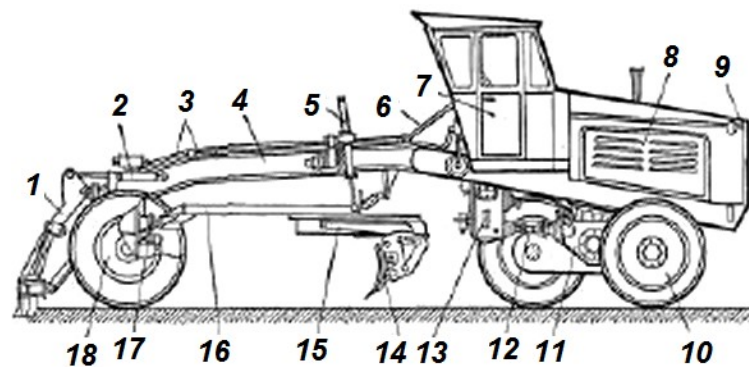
Конструктивна схема автогрейдера: 1 – розпушувач; 2, 5 – гідроциліндри; карданні вали; 4 – основна рама; 6 – вал рулевого колеса; 7 – кабіна; 8 – двигун; 9 – радіатор; 10 – задній міст; 11 – зчеплення; 12 – карданний вал; 13 – коробка передач; 14 – відвал; 15 – поворотний круг; 16 – рама поворотного круга; 17 – цапфа переднього моста; 18 – передній міст
